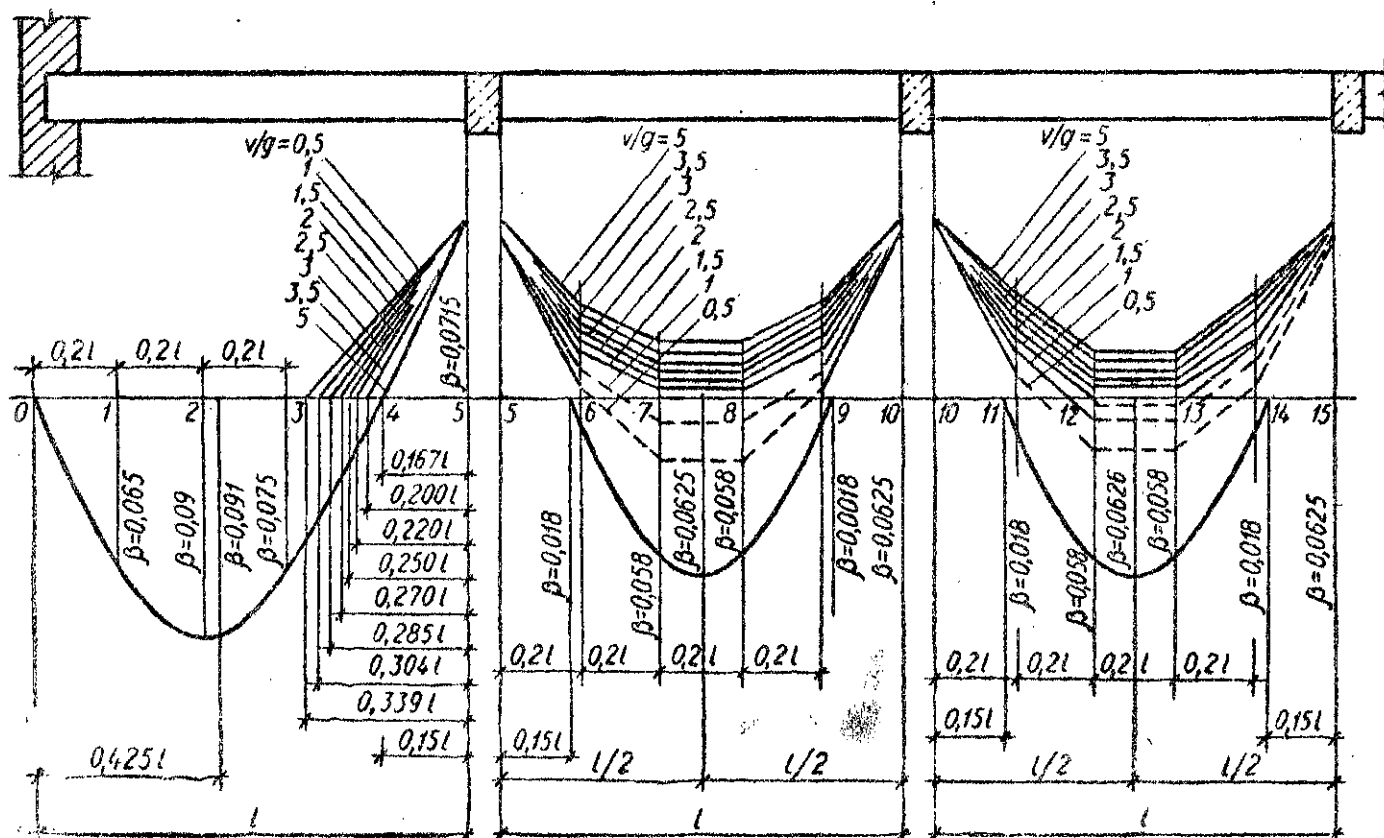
Епюри розрахункових моментів для розрахунку рівнопрольотних нерозрізних другорядних балок
